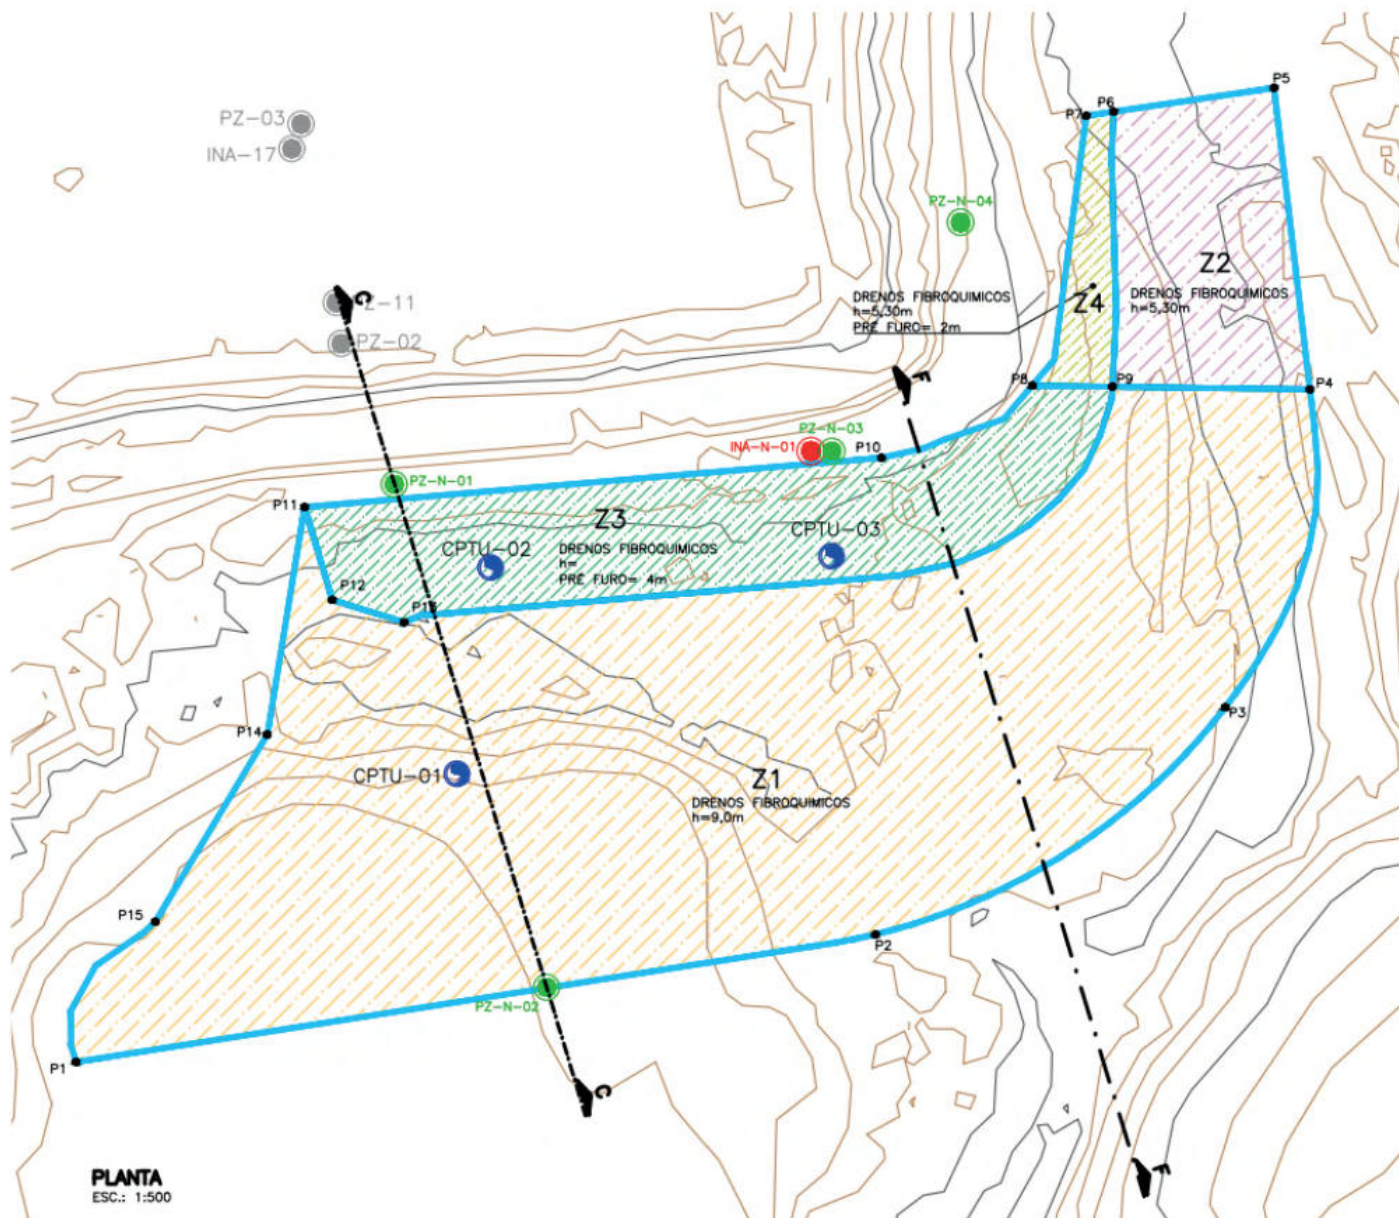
Planta do zoneamento para instalação dos drenos fibroquímicos
